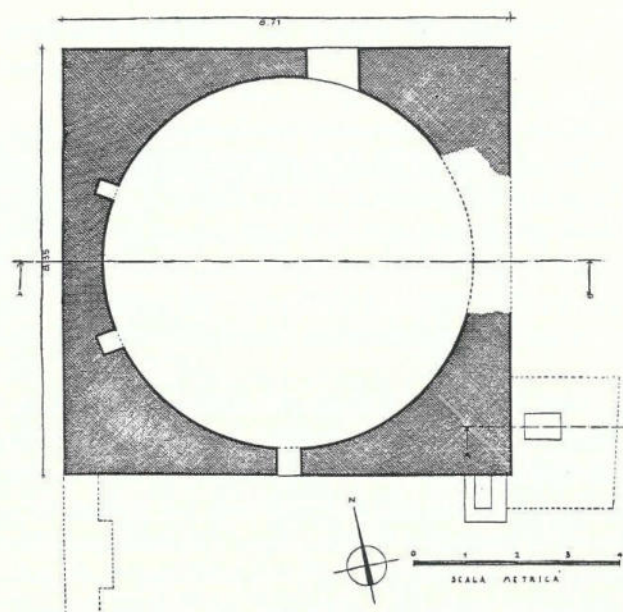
Noto, Contrada Falconara. Planimetria del rudere (da Agnello)
